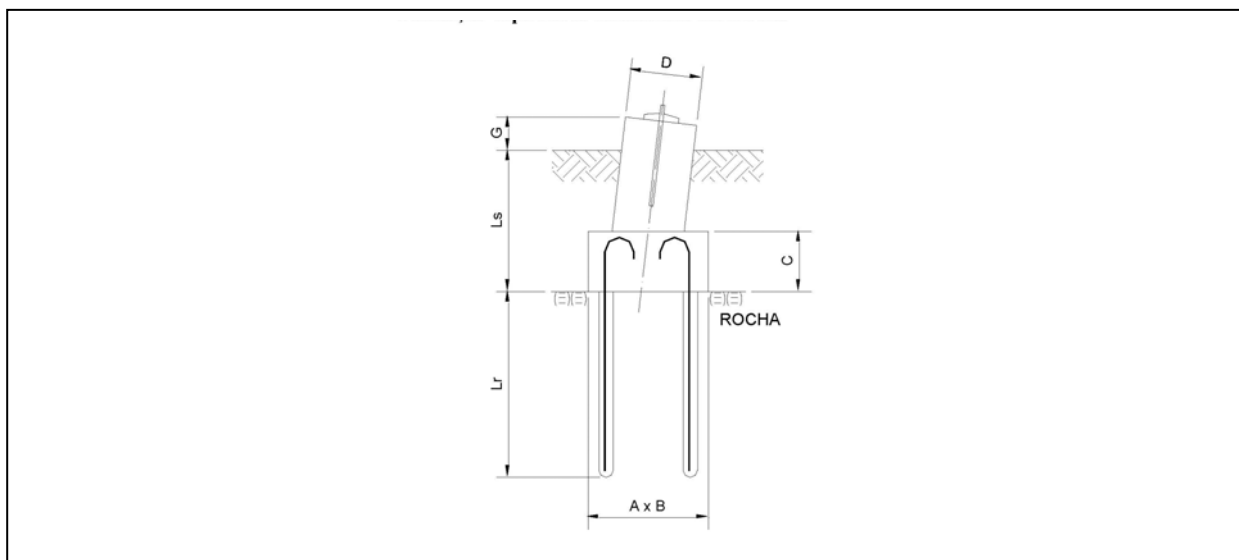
Fundação Tipo Bloco Chumbado em Rocha.
